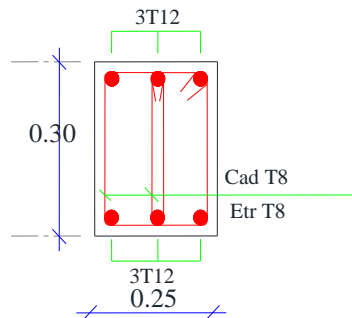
Schéma de ferrailage de la poutre chaînage.
